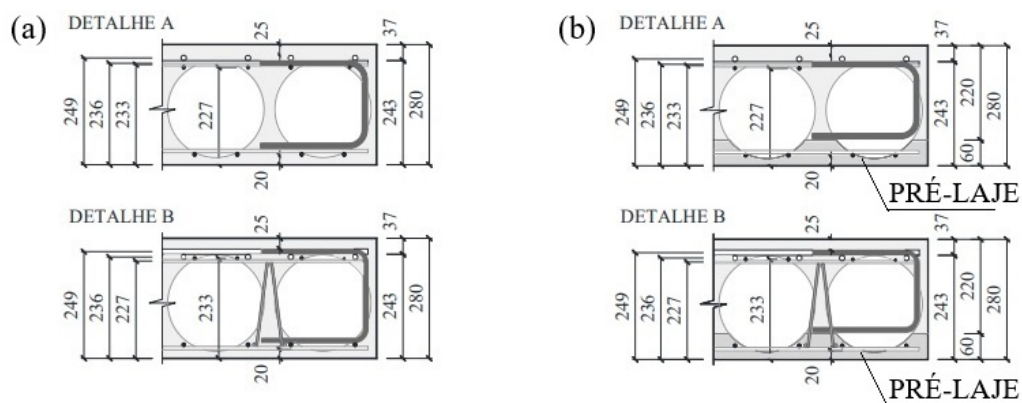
Detalhe das armaduras sem pré-laje (a) e com pré-laje (b) (dimensões em mm) (fonte: Nicácio (2018))
